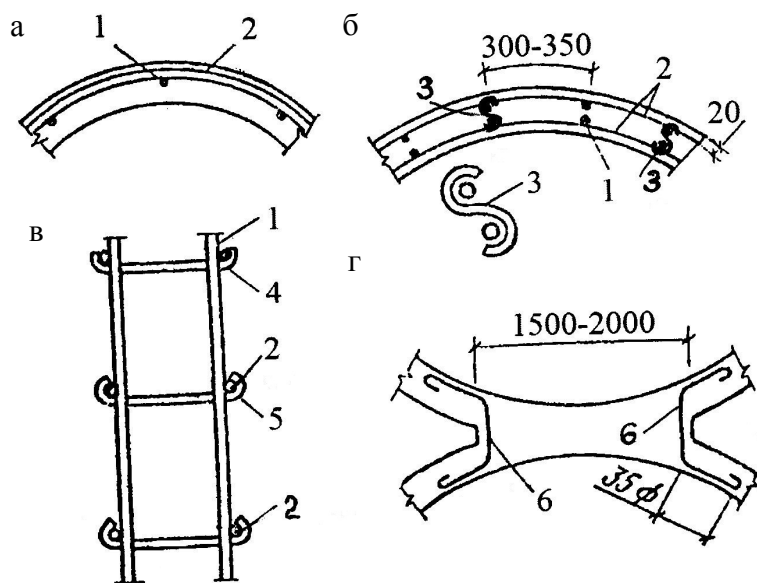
Детали армирования стен цилиндрических монолитных силосов: а – одиночное; б – двойное; в – вертикальный вязанный каркас; г – дополнительное армирование в местах сопряжения соседних силосов; 1 – вертикальные стержни; 2 – стержни кольцевой рабочей арматуры; 3 – соединительные шпильки; 4, 5 – хомуты до и после укладки горизонтальных стержней; 6 – дополнительные стержни
